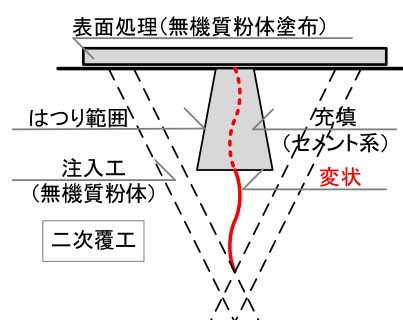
対策の例 (漏水をとまなうひび割れの場合)
